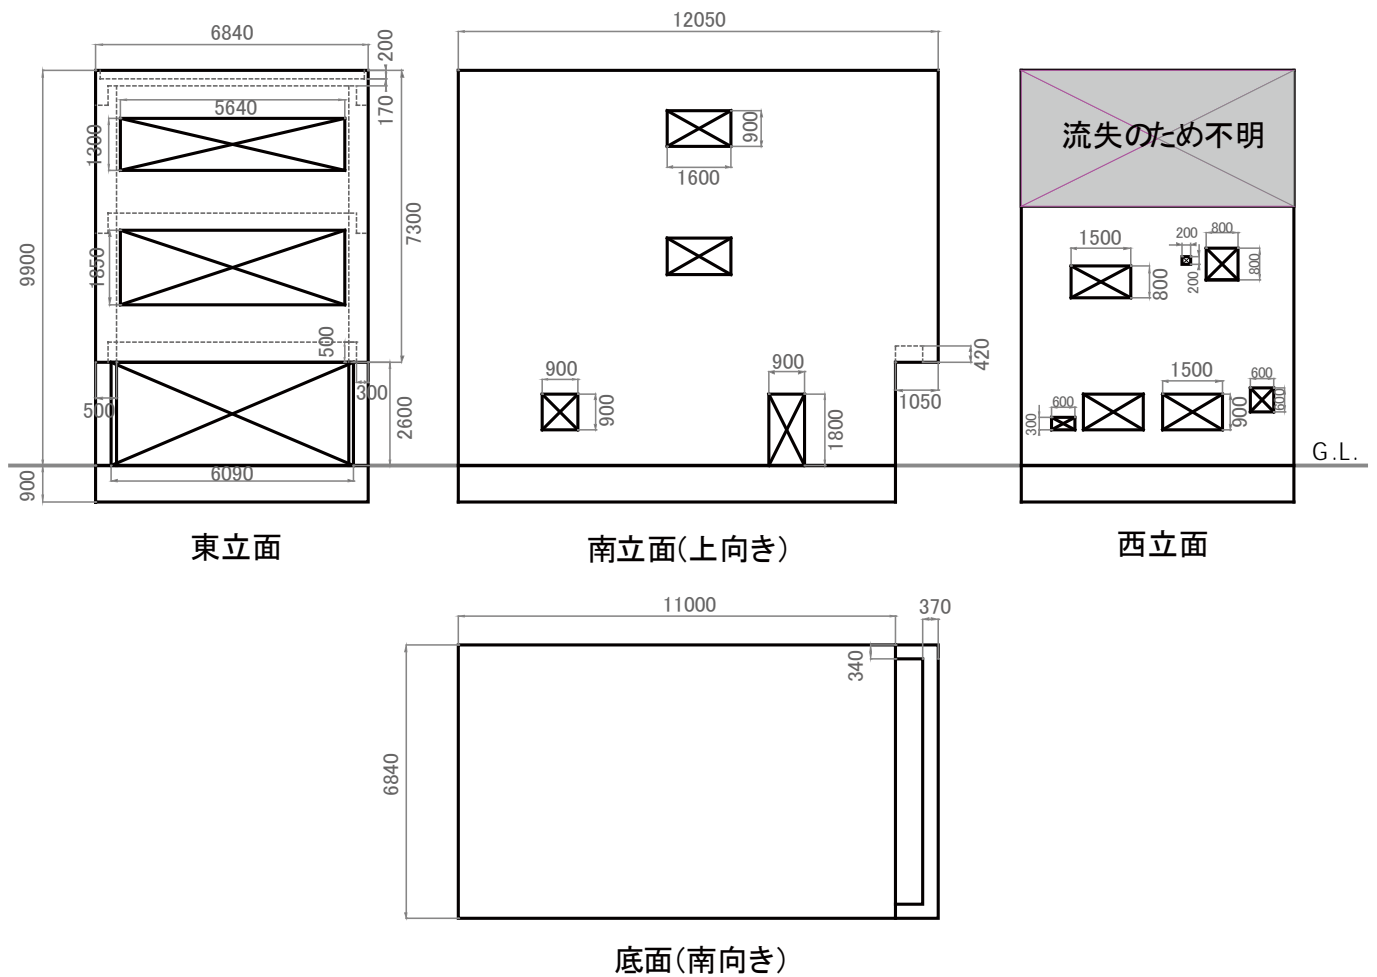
調査対象建物 立面図・見付図 (単位: mm)
